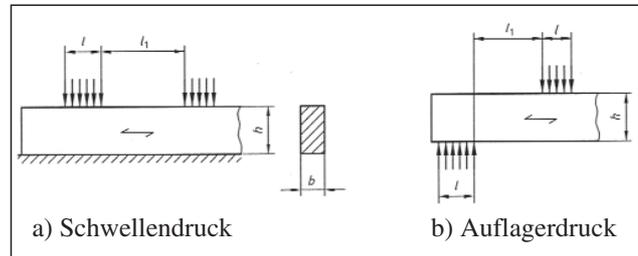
Druck rechtwinklig zur Faserrichtung des Holzes
